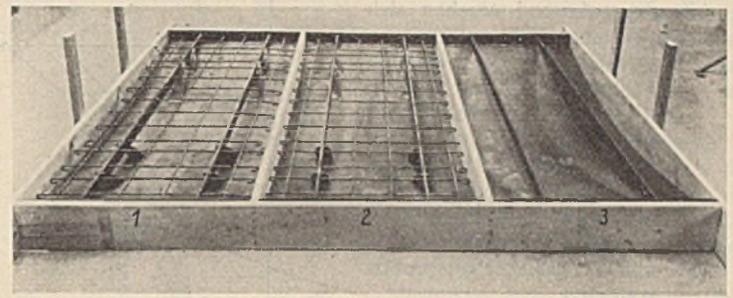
Versuchskörper I, II und III vor dem Ausbetonieren.
